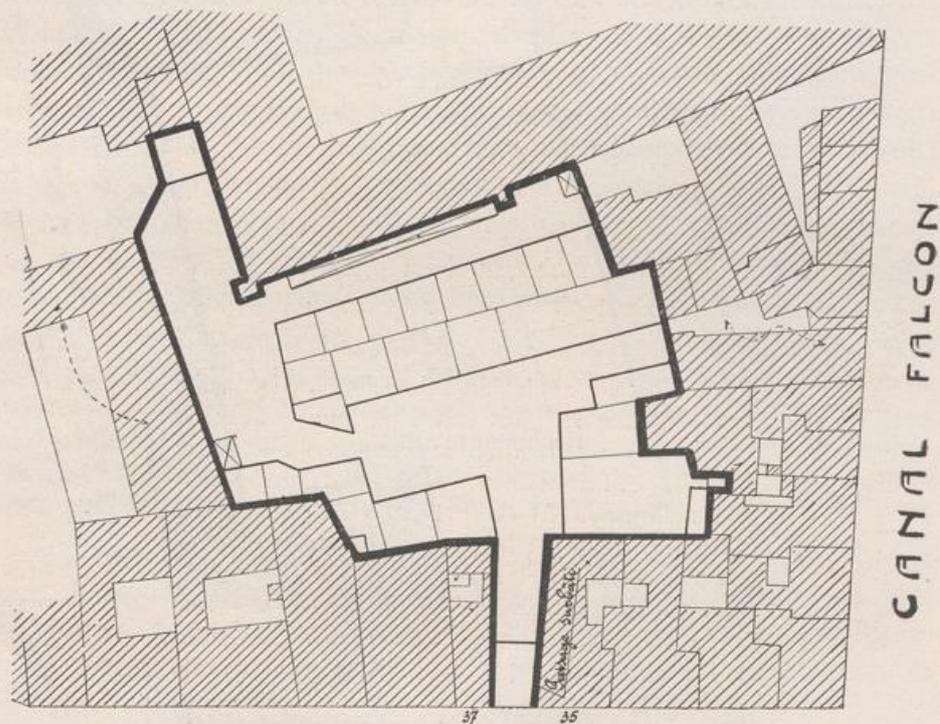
Falconhof, Grundriß. Maßstab ca. 1 : 800.
